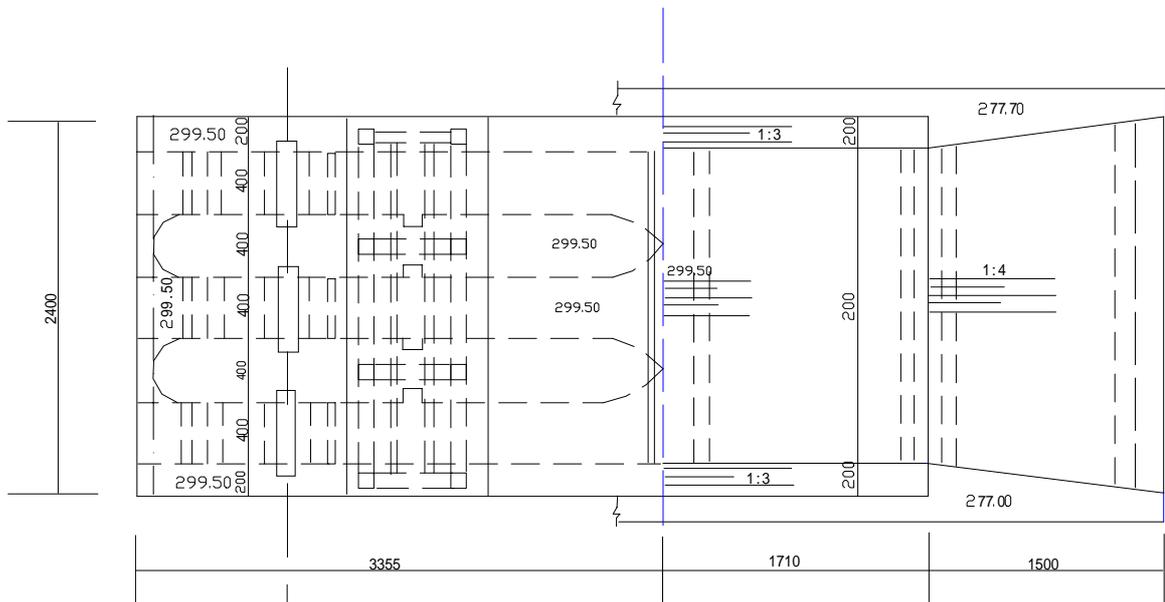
冲砂闸混凝土浇筑分块平面示意图
